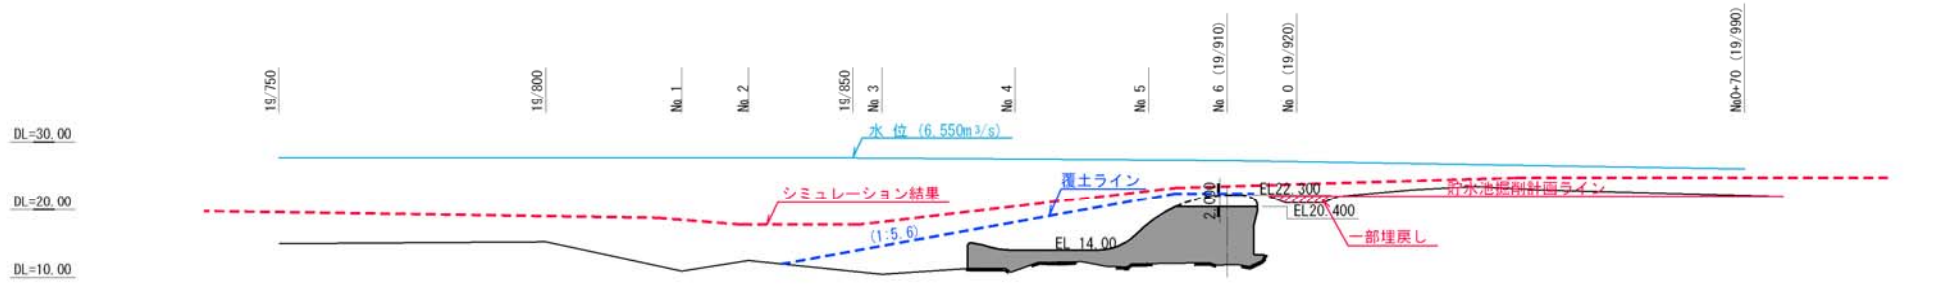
河床縦断面図(覆土量 1.5万 m³)
